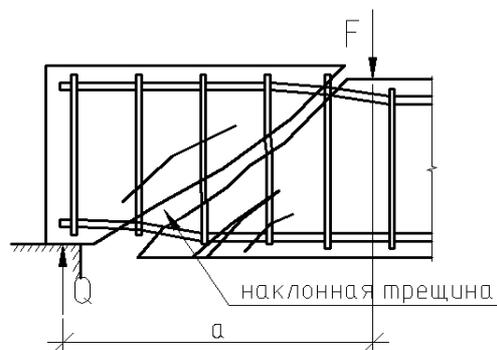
Сдвиг по наклонному сечению от действия поперечной силы
